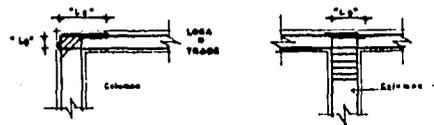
DETALLES CONSTRUCTIVOS
